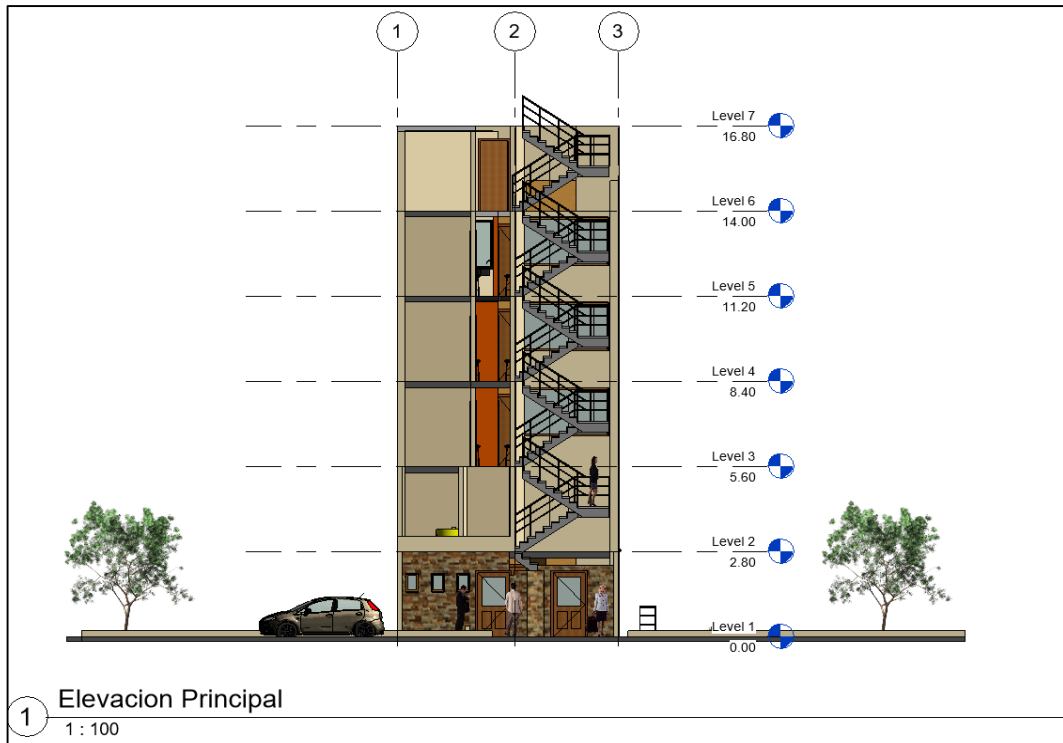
Arquitectura: elevación Principal. Fuente: Propia.
